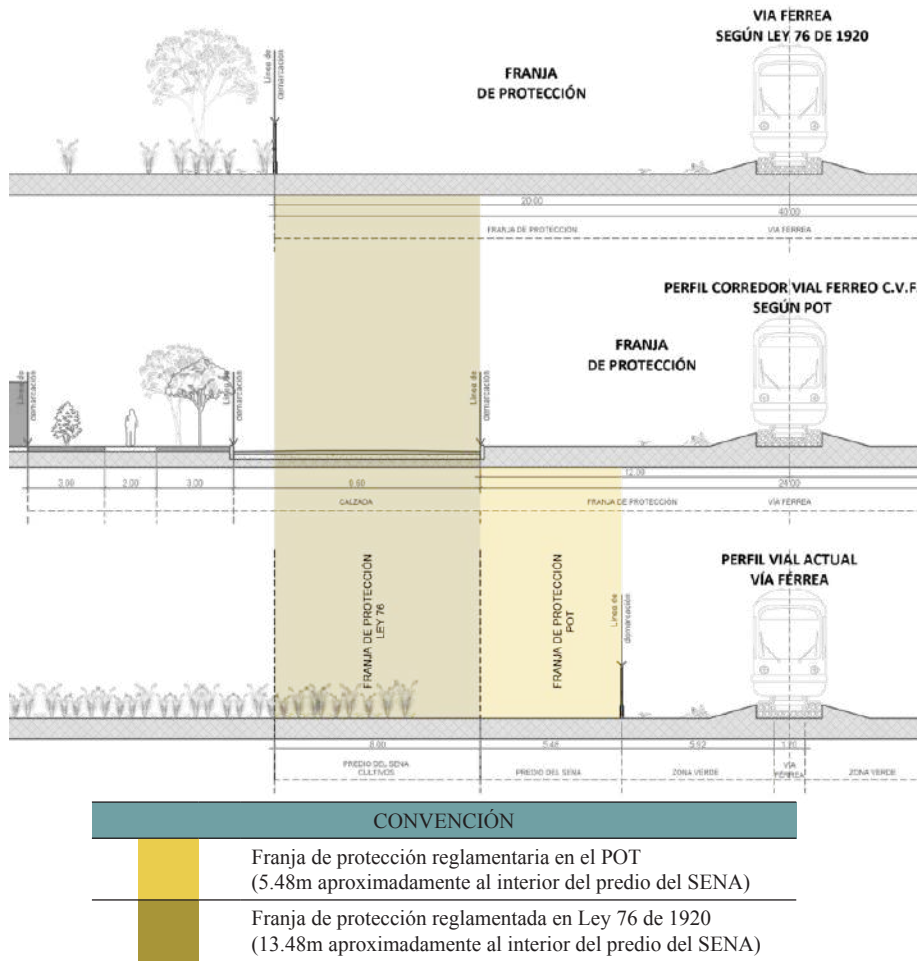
Relación de las dimensiones reglamentadas en la Ley 76 de 1920, en el POT para Corredor Vial Férreo C.V.F. con el perfil vial existente. Elaboración área normativa UD. Fecha elaboración: 04/11/2016, dimensiones tomadas del levantamiento topográfico realizado por la Universidad Distrital.
